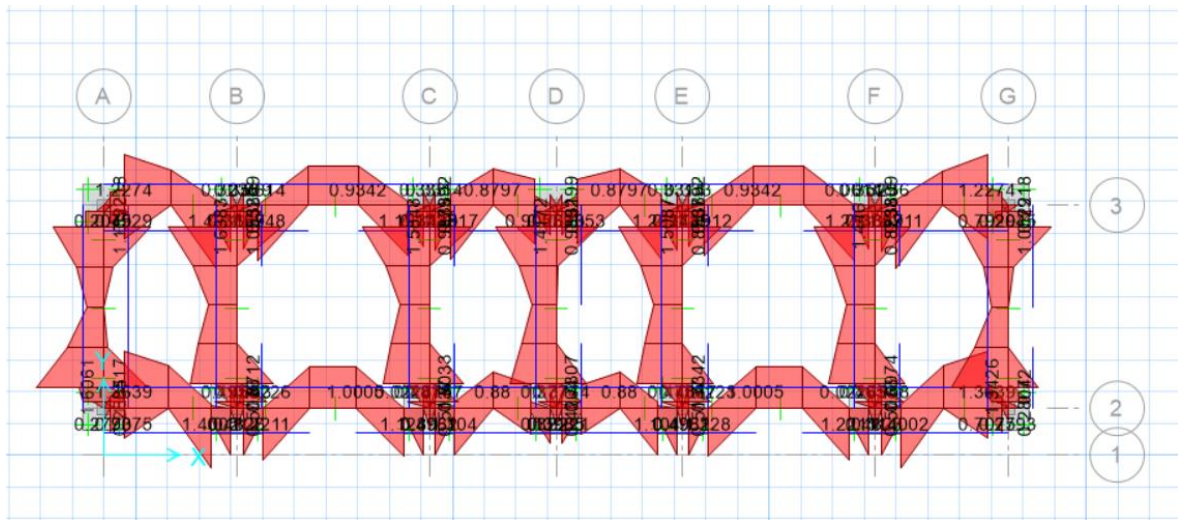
Acero de refuerzo en cadenas de amarre.
